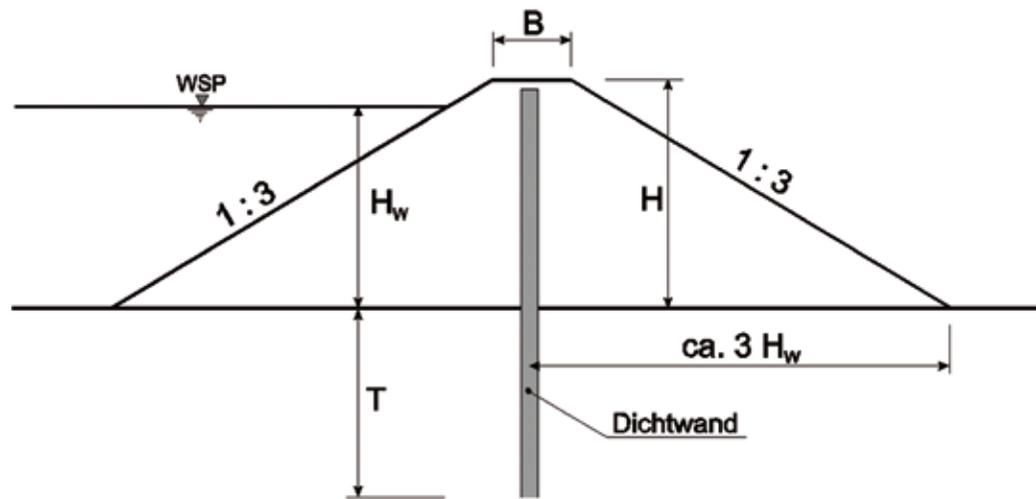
Bautyp – Damm und Untergrundabdichtung mit Betondichtwand
